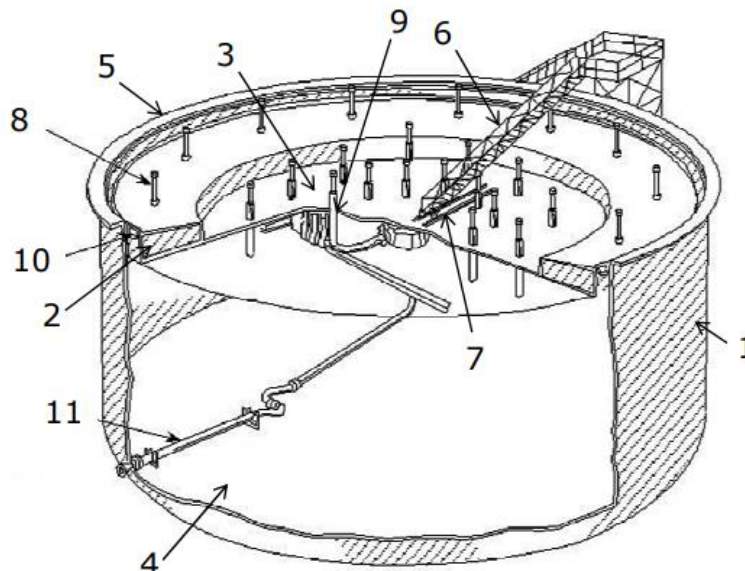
Схема резервуару з плаваючим дахом: 1 – оболонка; 2 – понтон; 3 – мембрана; 4 – дно резервуару; 5 – вітрове кільце; 6 – розкладні сходи; 7 – доріжка для обслуговування резервуару; 8 – опори покрівлі; 9 – аераційний клапан; 10 – герметизація плаваючого даху; 11 – дренаж покрівлі
